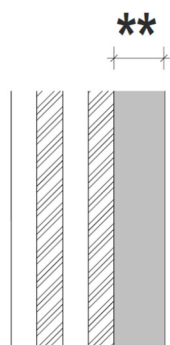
Standardaufbau der MHM – Wandelemente mit 5 Lagen
